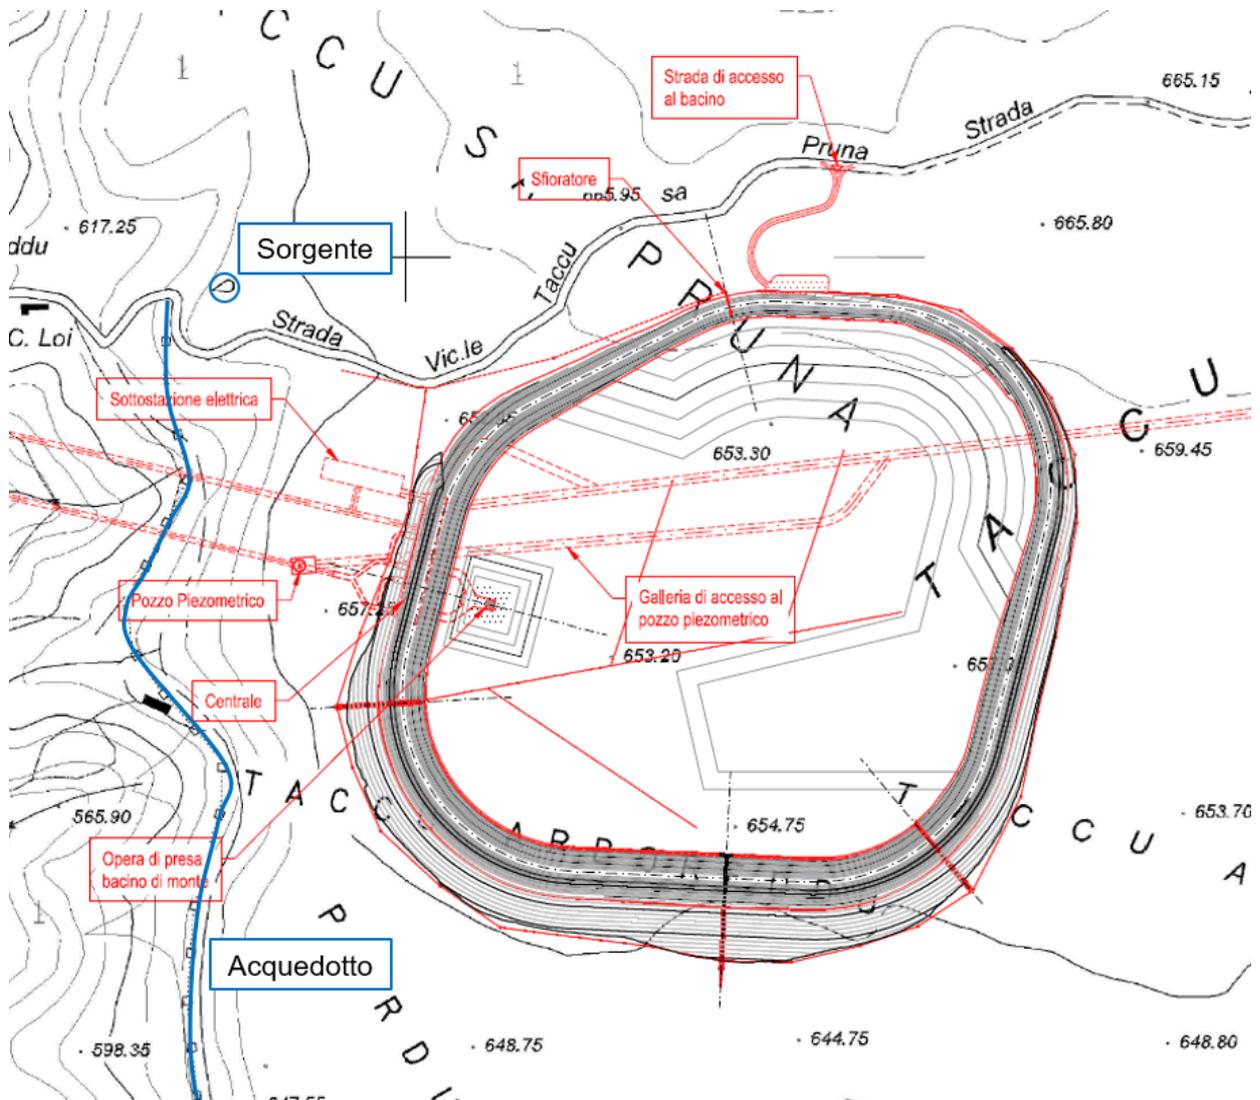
Localizzazione della Sorgente (cerchio blu) e dell’Acquedotto (linea blu) rispetto al layout di Progetto
